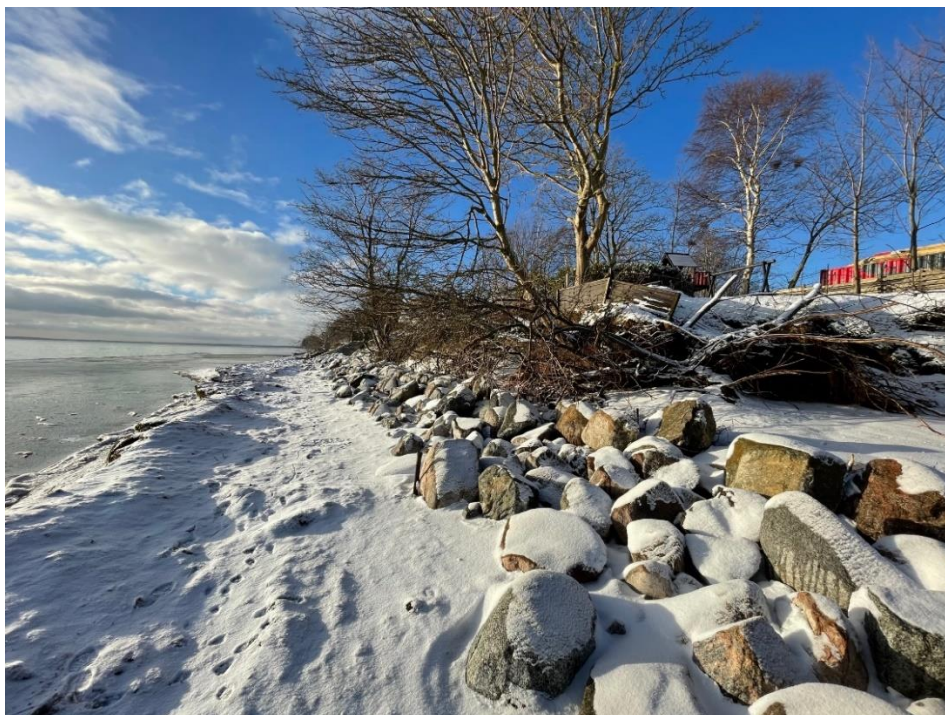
Den brede strand umiddelbart udfør hovedbygningen. Bemærk den lave betonmur og lav kystskrænt ovenfor med bevoksning
